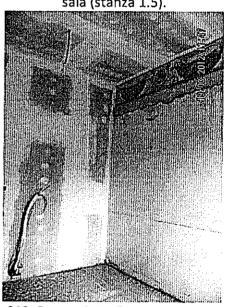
Stanza 1.4- Vista interna.parte lato bagno.
